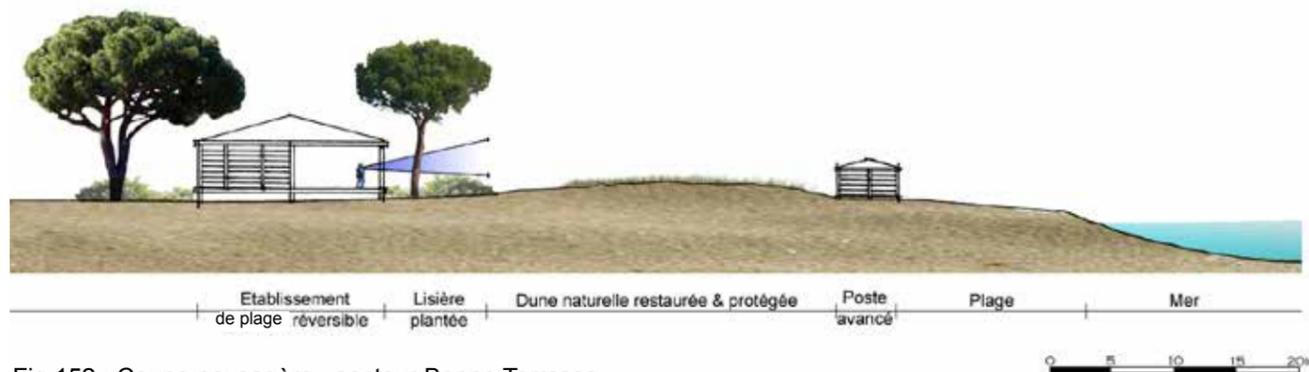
Coupe paysagère - secteur Bonne Terrasse
